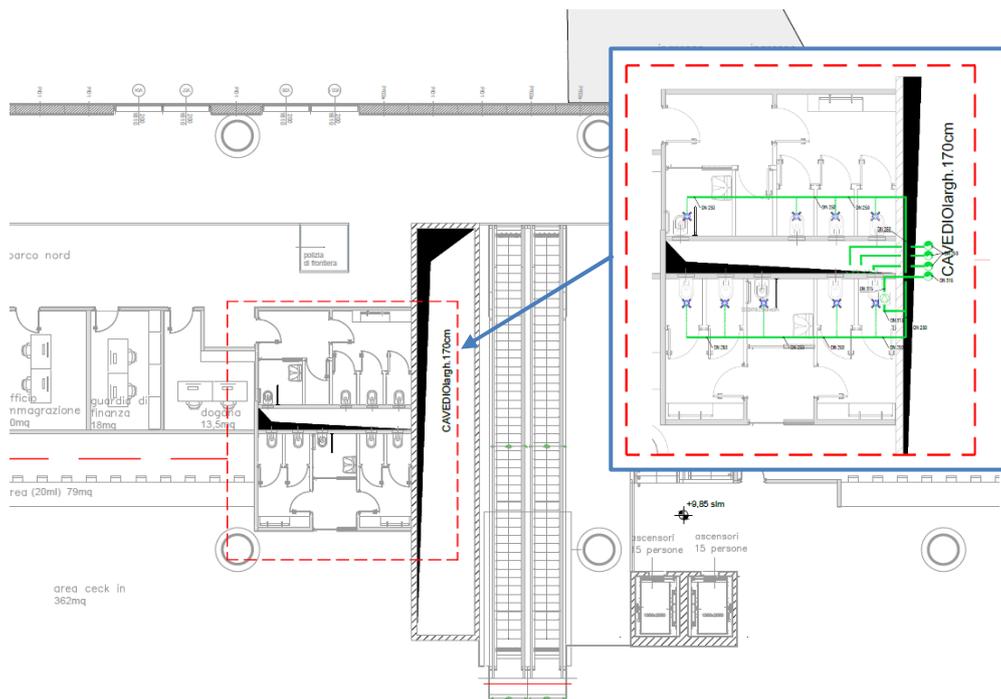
Edificio Terminal, piano primo: Impianto estrazione aria servizi igienici
